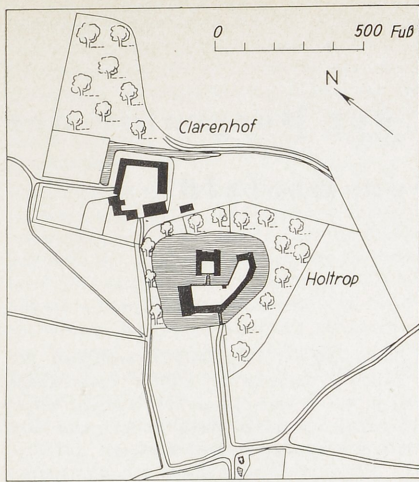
Holtrop, Ausschnitt aus Lageplan 1738 (G. Frick)
